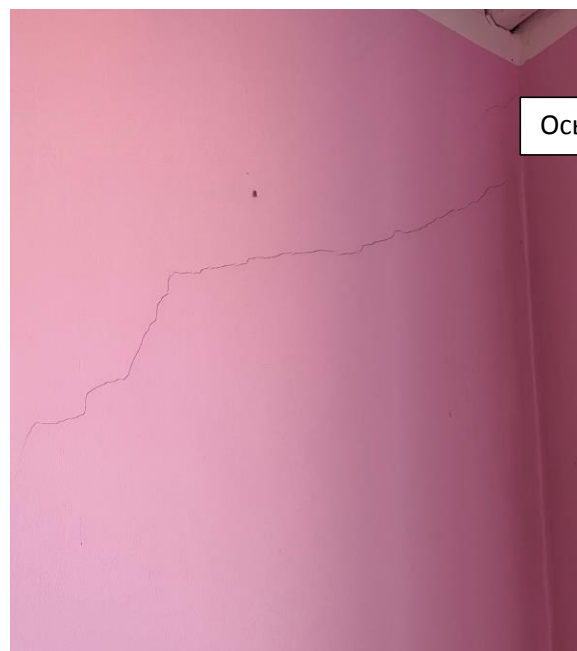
Трещины на стене по оси «Б» в верхних углах на втором этаже.
